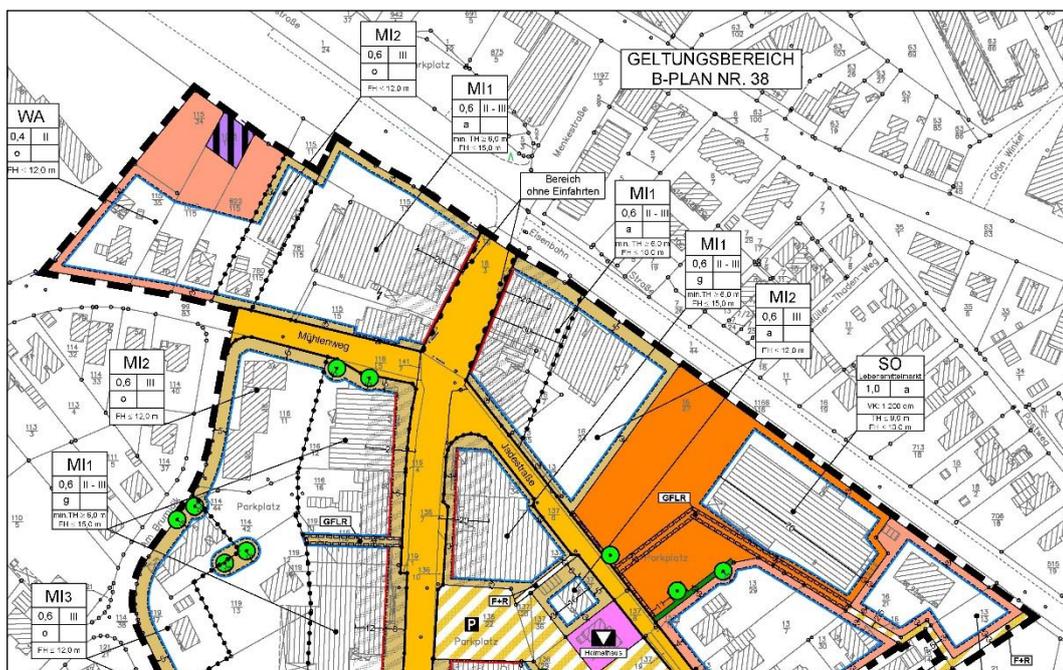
Ausschnitt aus dem nördlichen Geltungsbereich, Ursprungsplan Nr. 70 „Menkestraße“
